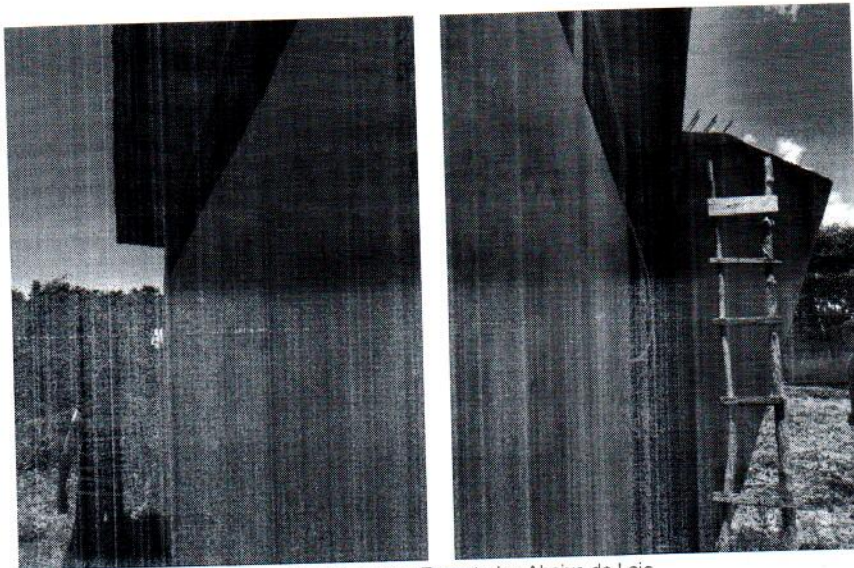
e 14 – Vigas Executadas Abaixo da Laje
